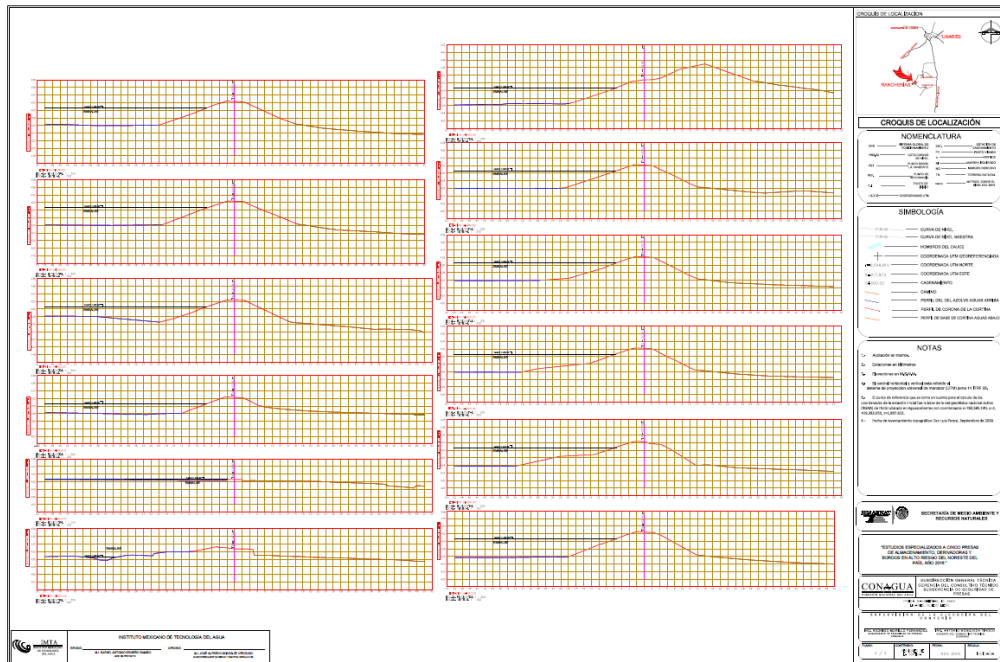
Plano de secciones de la cortina de la presa Rancherías.
